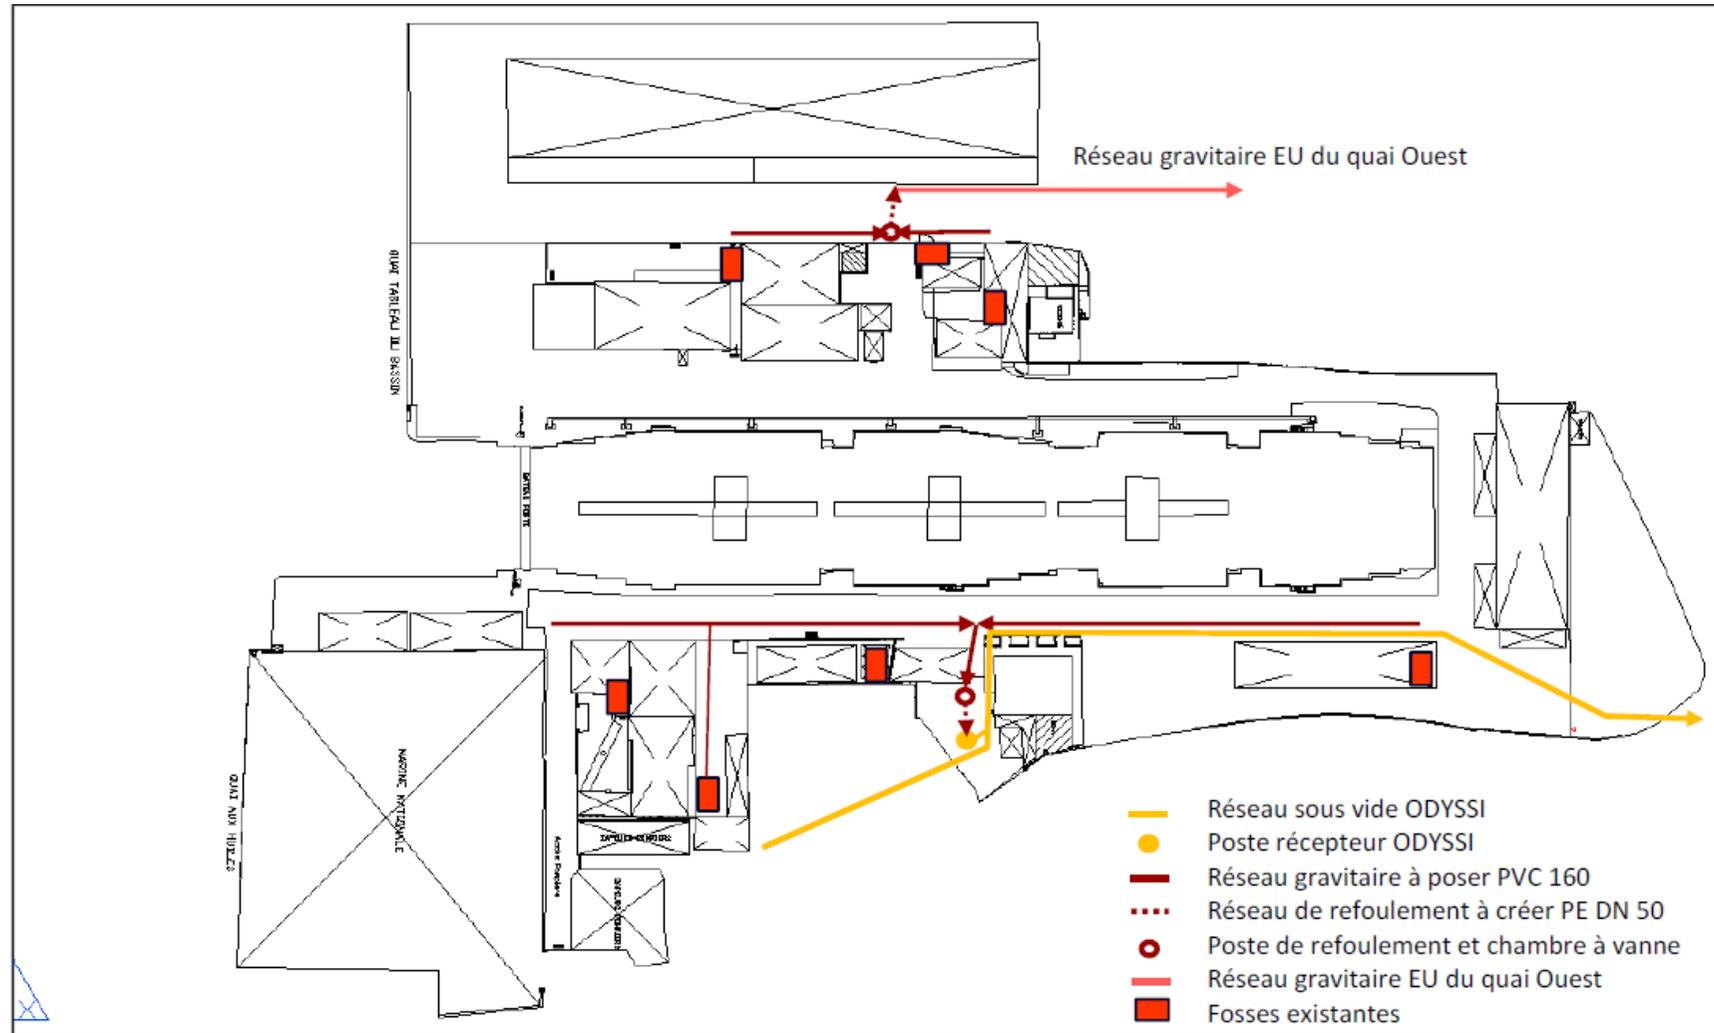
Plan projet de la configuration du réseau eaux usées domestiques sur le bassin de Radoub
